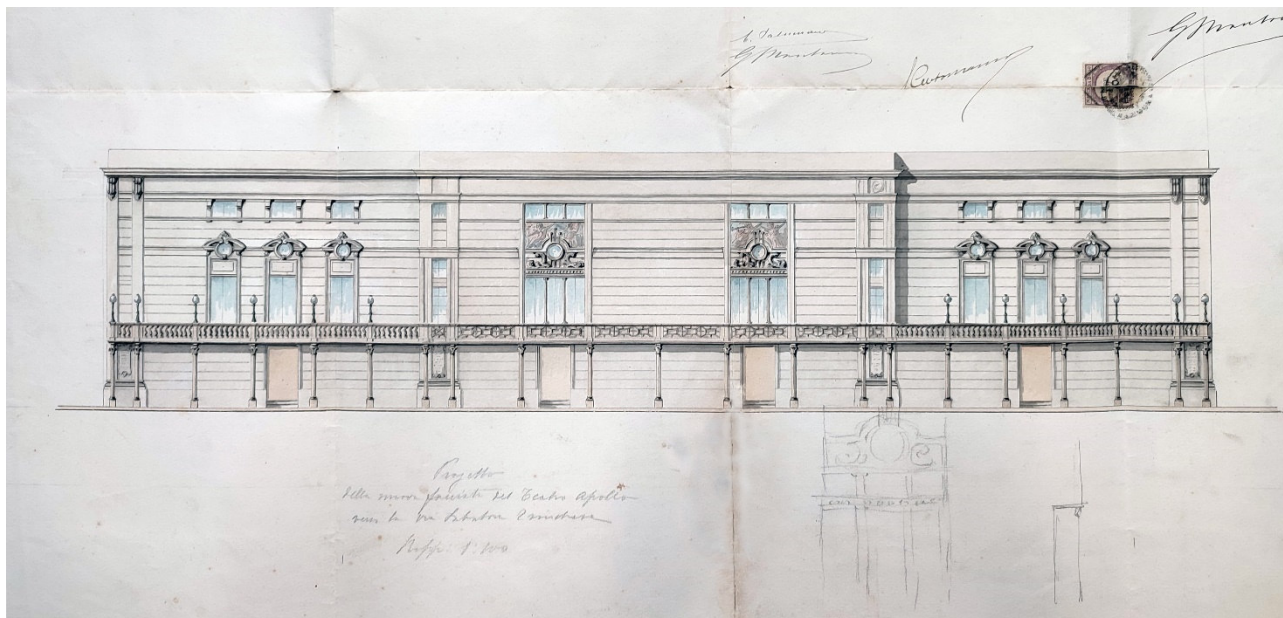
Progetto del prospetto laterale su Via Trinchese, 1926 (ASCL, Cat. V Finanze)
